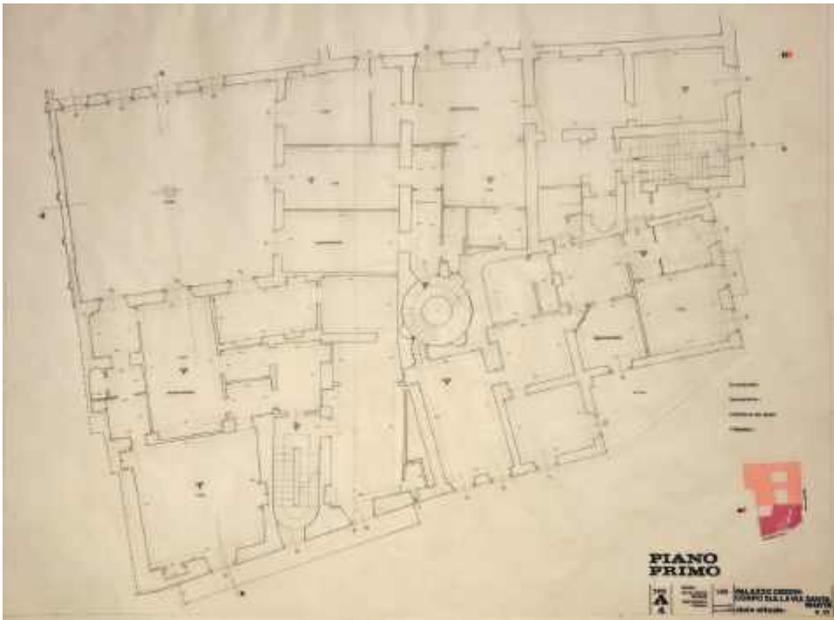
Corpo su via Santa Marta, pianta piano primo, rilievo stato di fatto; tavola su lucido
